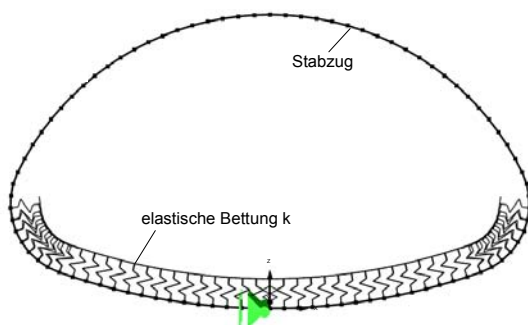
Modellierung des Wellstahlbauwerks als elastisch gebetteter Stabzug
